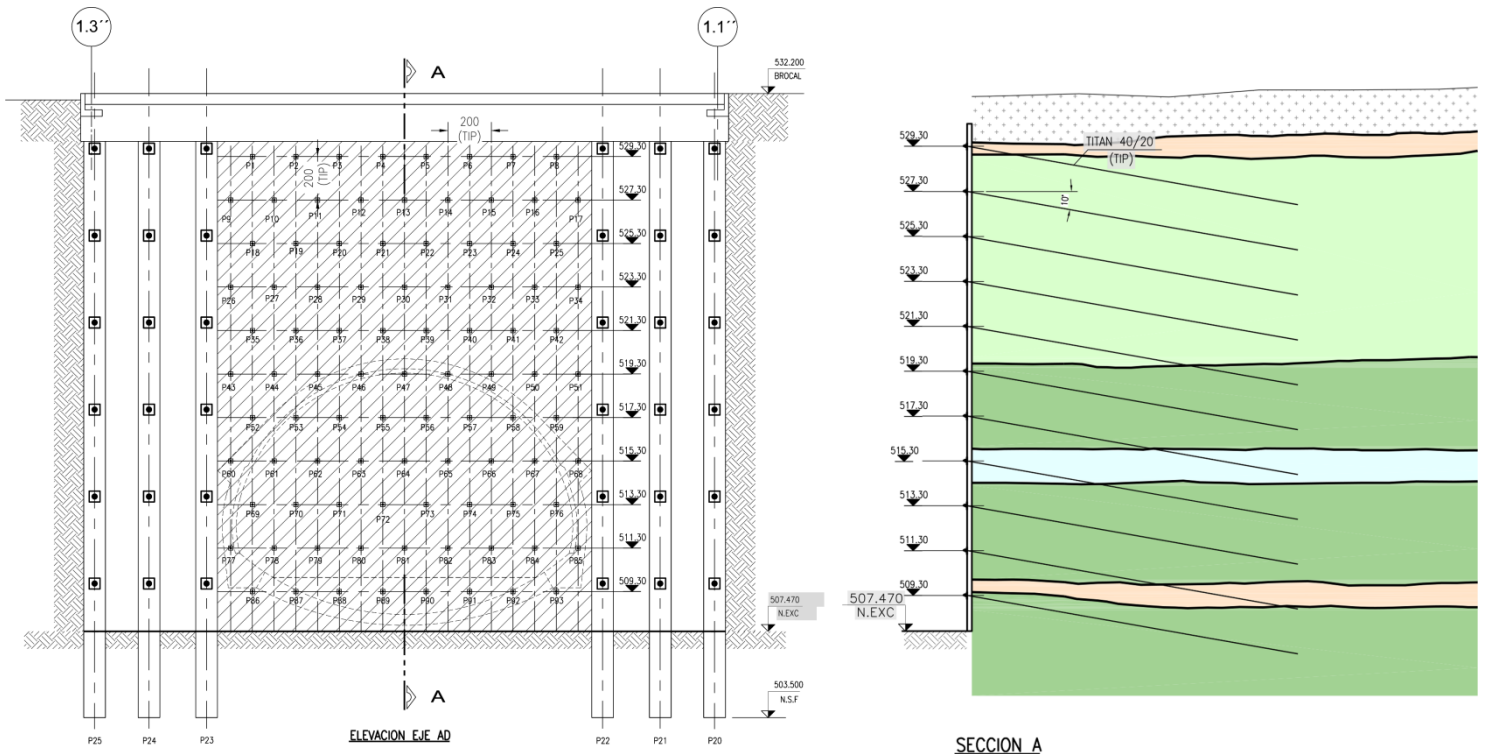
Vista en Corte del Soil Nailing la Estación Franklin.
